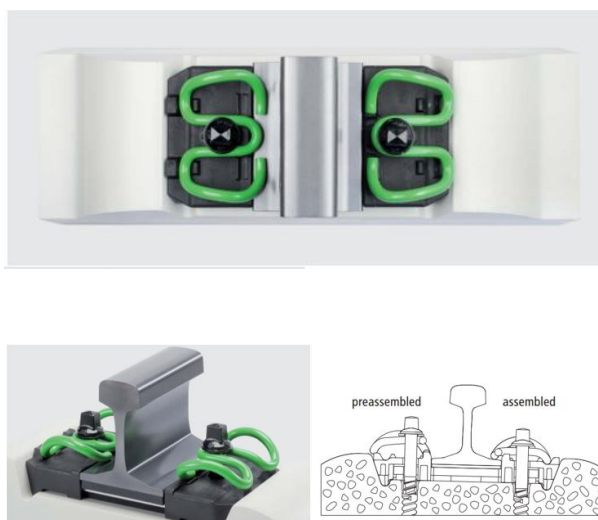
Sistema de fijación Vossloh 300 con clip elástico SKL 15 FUENTE: Rail fastening system for slab tracks. System 300 (Vossloh)^[28]
